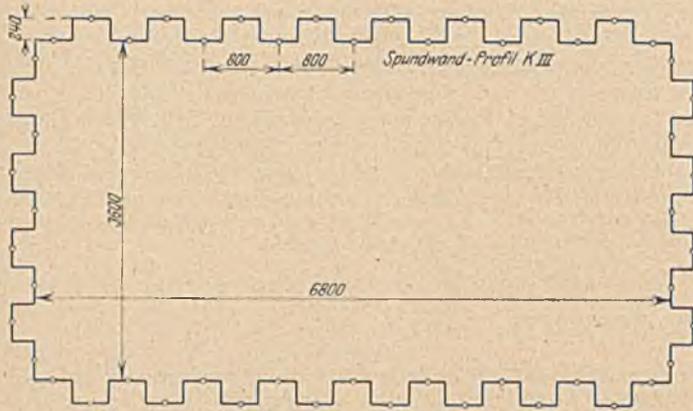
Grundriß einer Baugrube aus Spundwand K III.
